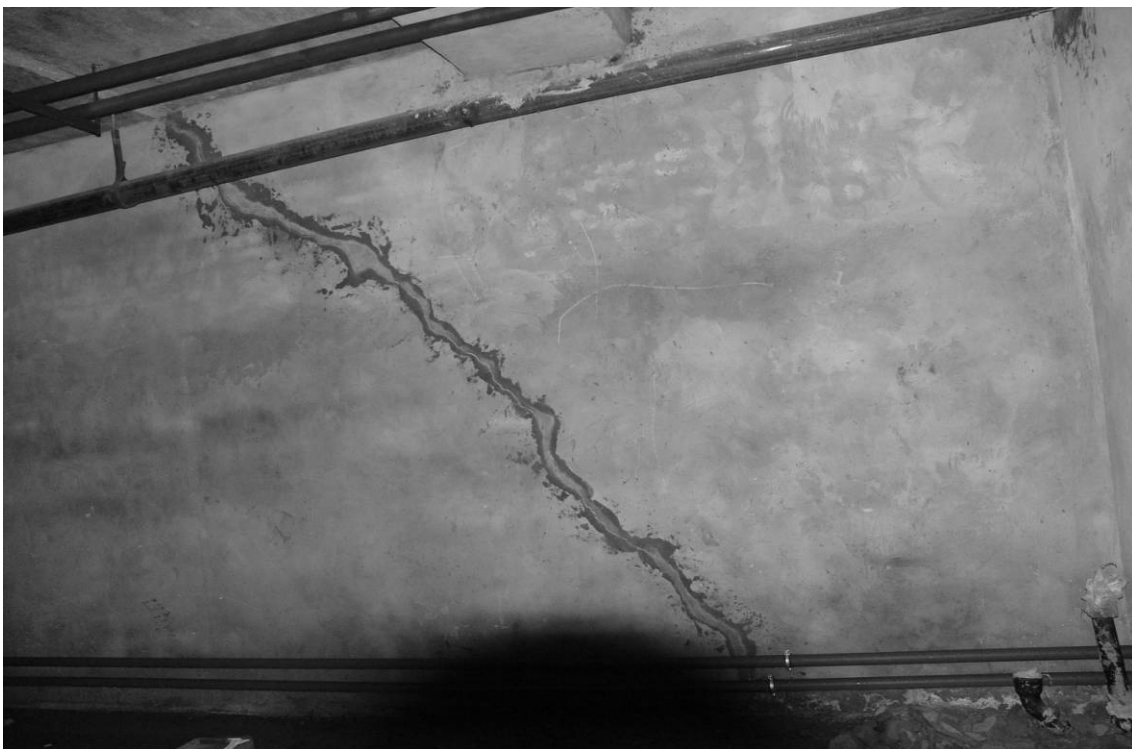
Наклонная осадочная трещина в перегородке цокольного этажа
